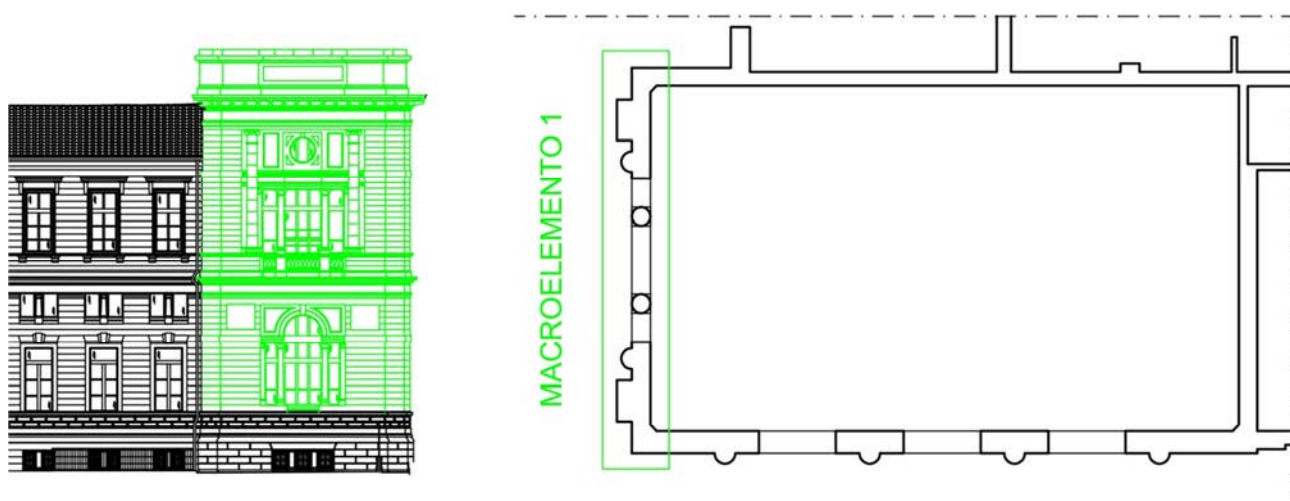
Individuazione del macroelemento sul prospetto e in pianta.
